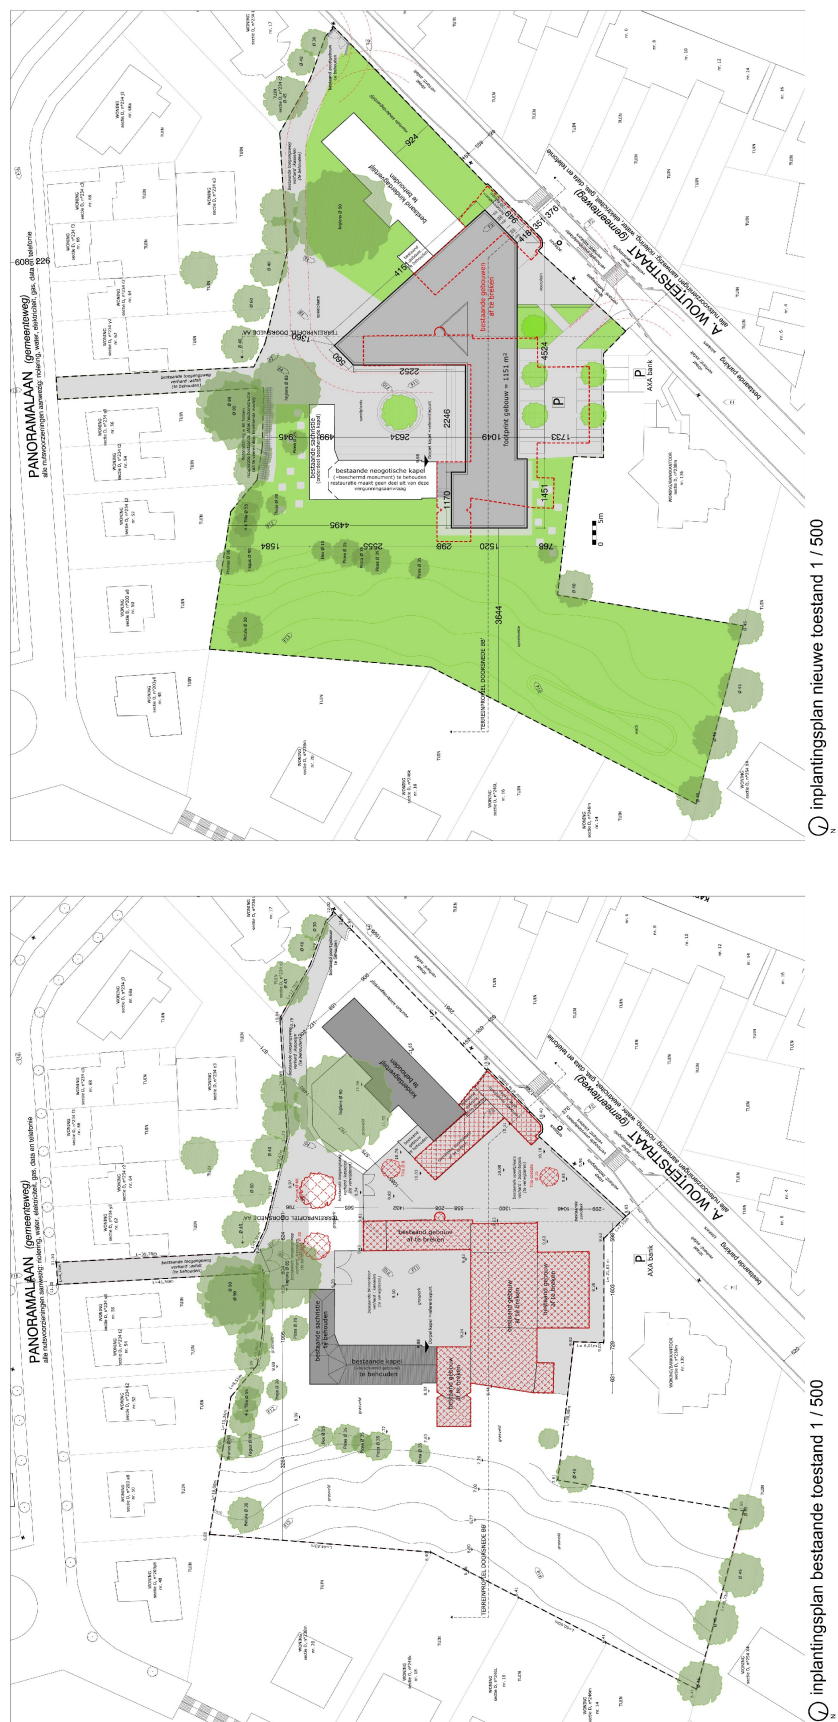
Plan bestaande toestand (onder) en ontwerpplan (boven)
